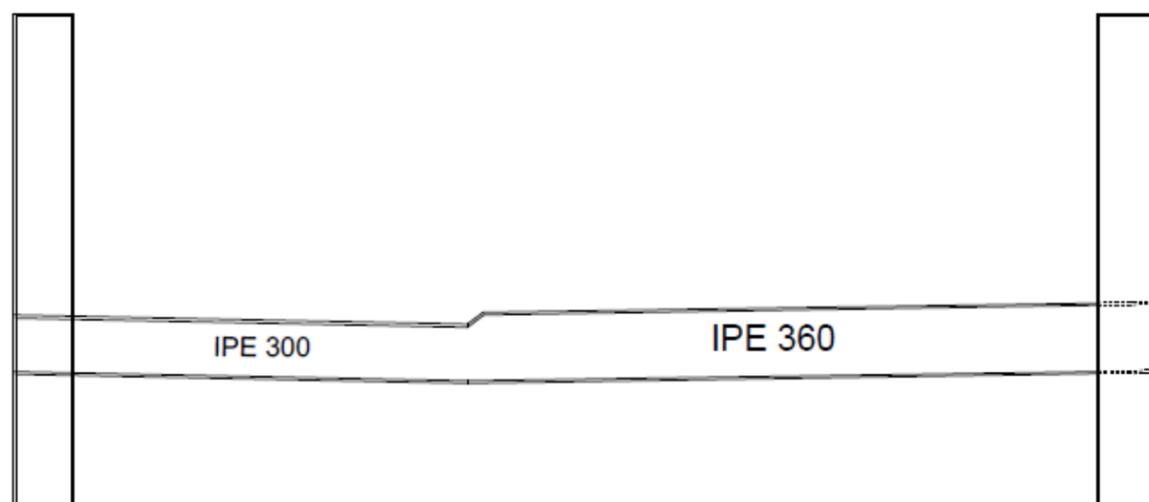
Disposición de vigas transversales (alternativa descartada))
